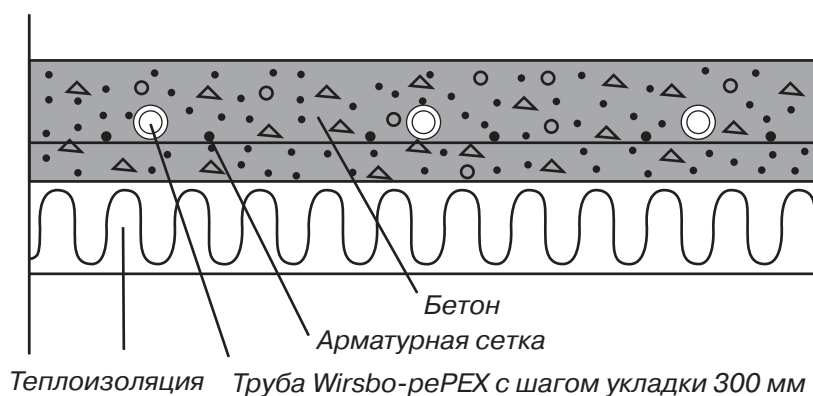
Бетонный пол на теплоизоляции. Петли трубы уложены на сетку и закреплены крепежной проволокой до бетонирования.
